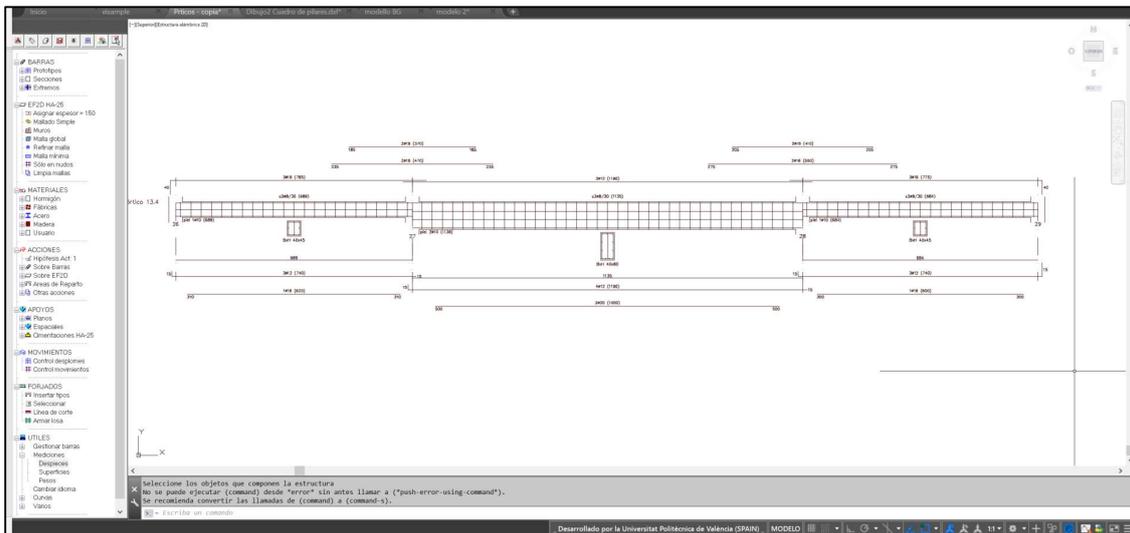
Medición correspondiente a varias vigas de hormigón armado
